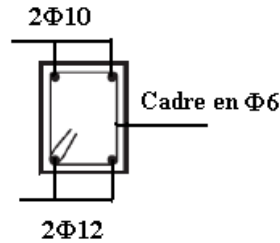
La coupe transversale (A-A) pour la poutre 8.
